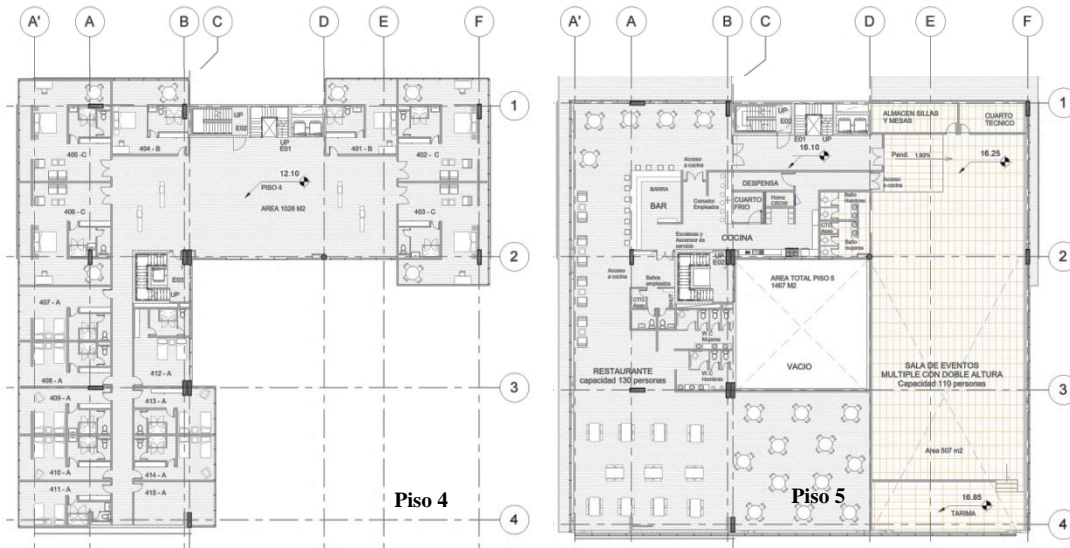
Plantas tipo del elemento arquitectónico en pisos 4 y 5, Hotel y Centro Empresarial
